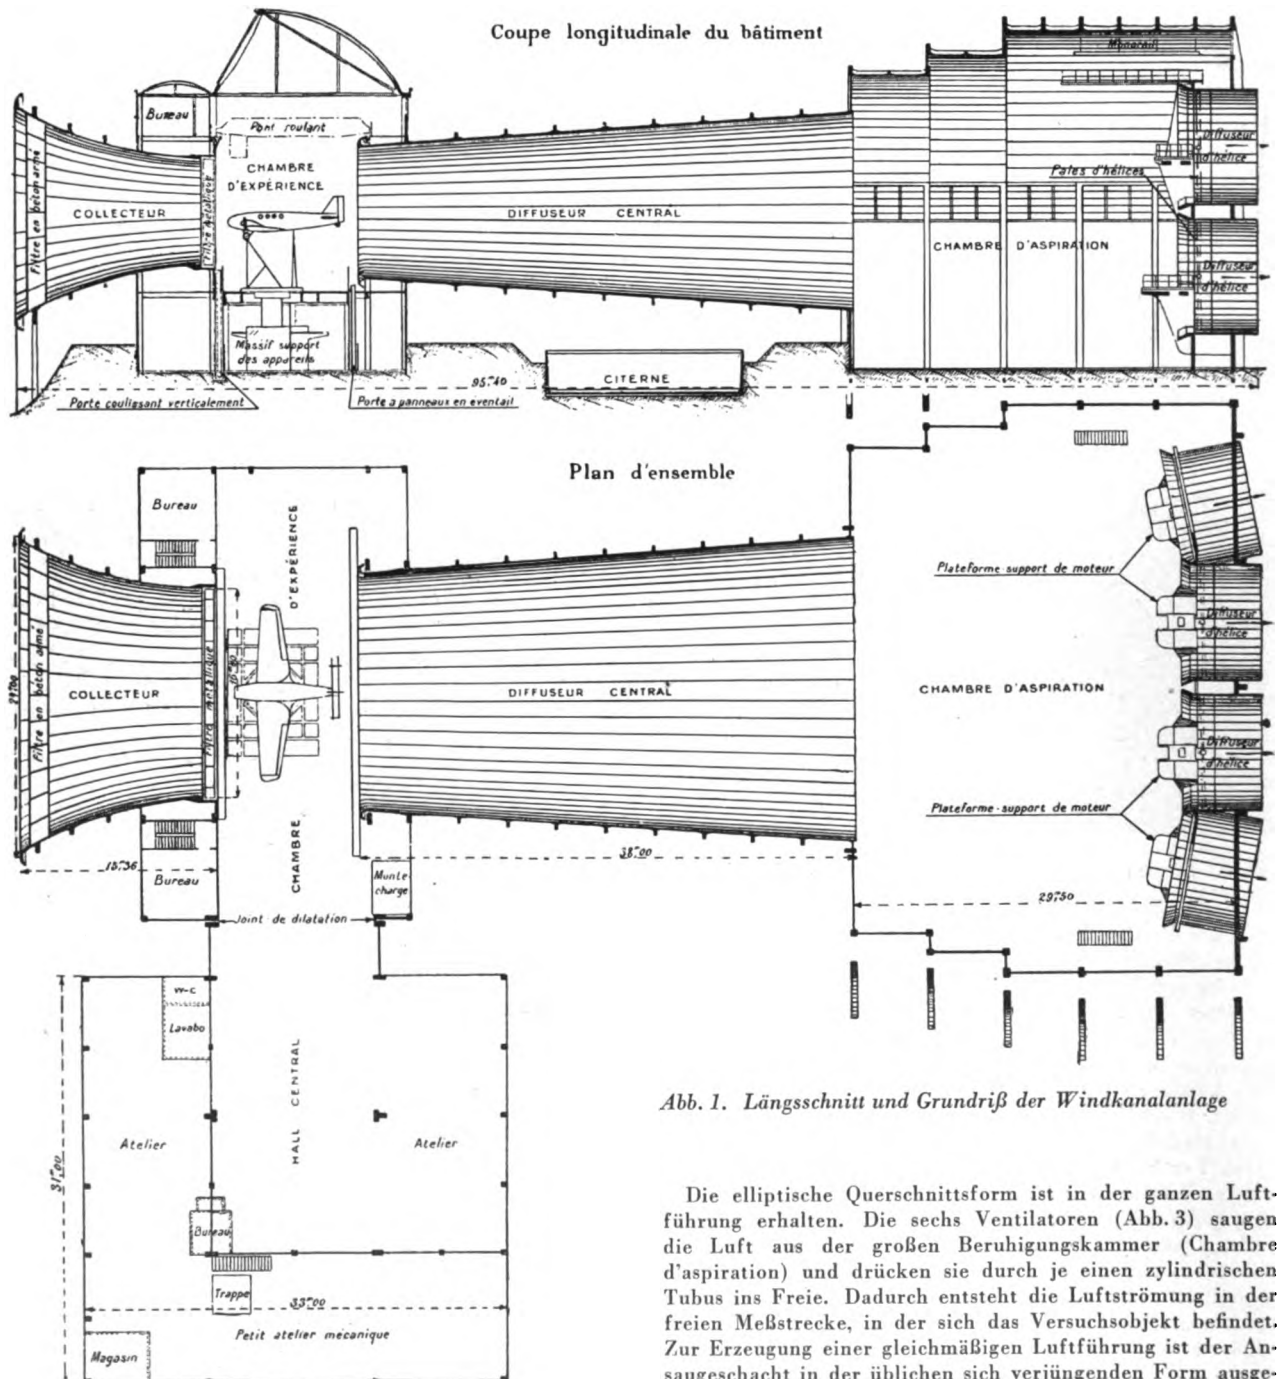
Längsschnitt und Grundriß der Windkanalanlage
